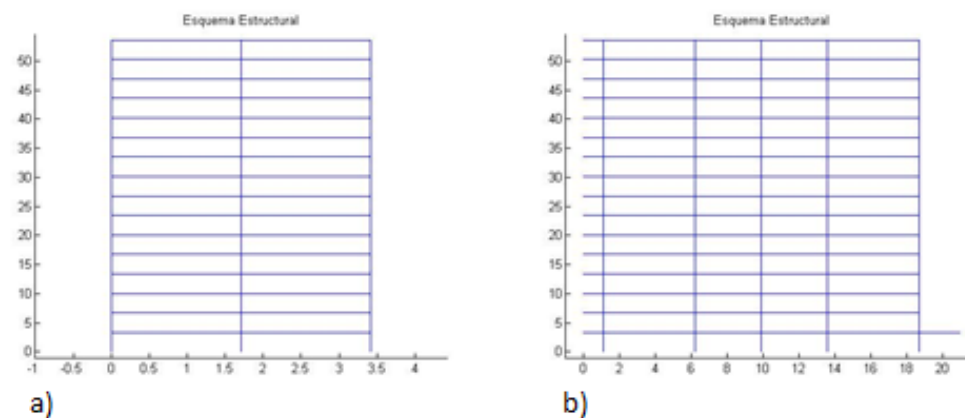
Pórticos longitudinales sin reforzamiento a) Pórtico D'; b) Pórtico E.
